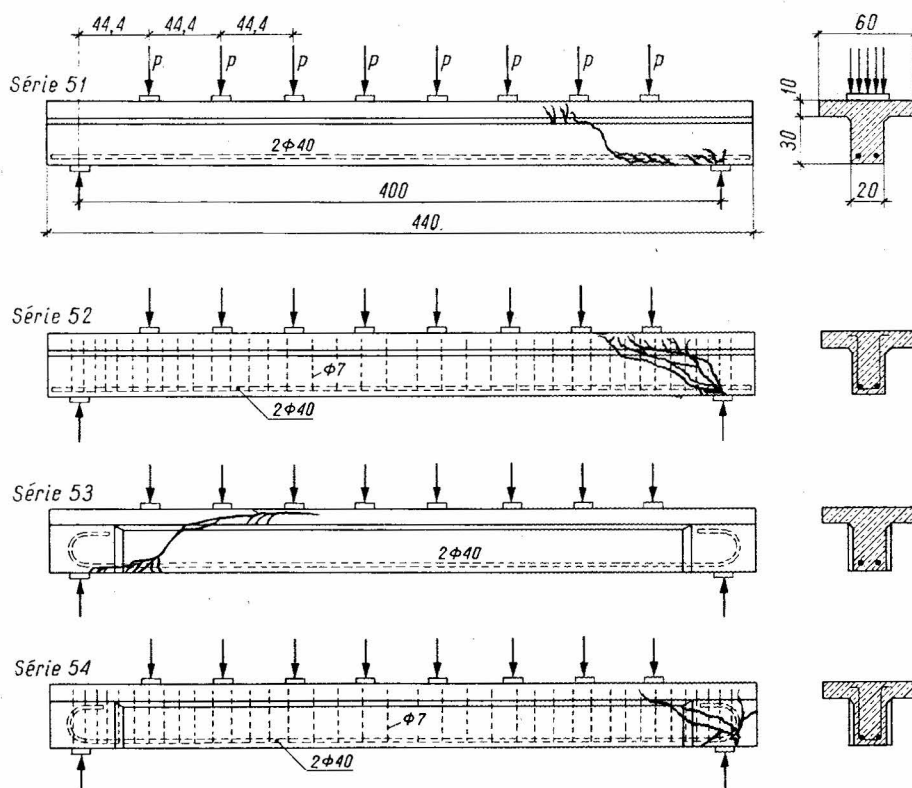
Poutres dans les essais de DAfE, cahier 20 [2]
